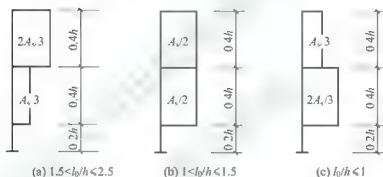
连续深梁中间支座截面纵向受拉钢筋在不同高度范围内的分配比例
